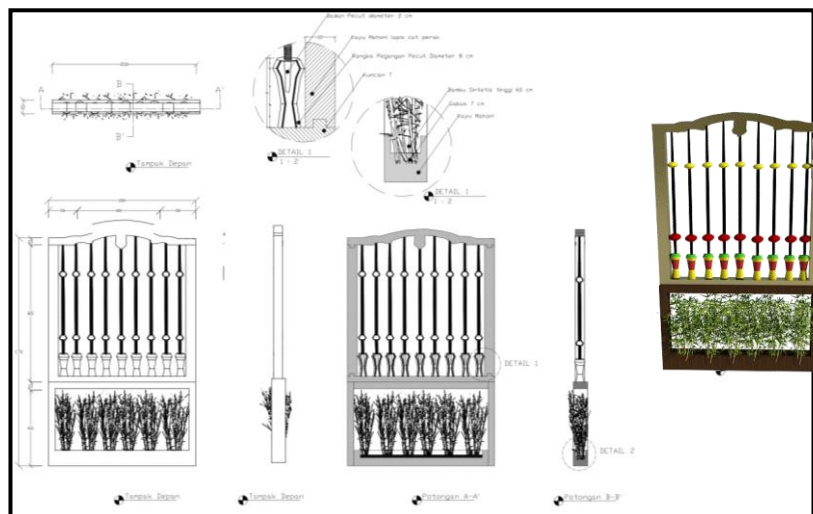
Detail Furnitur 1 Ruang Makan Shinta
